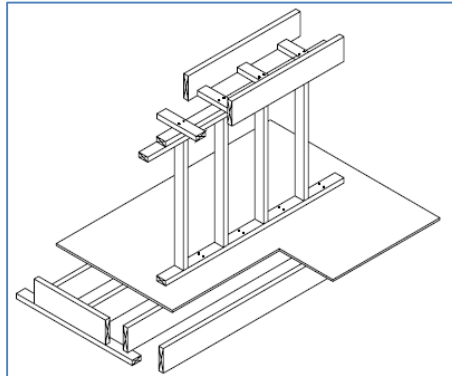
Forjado sobre el que apoyan paredes sin carga.
